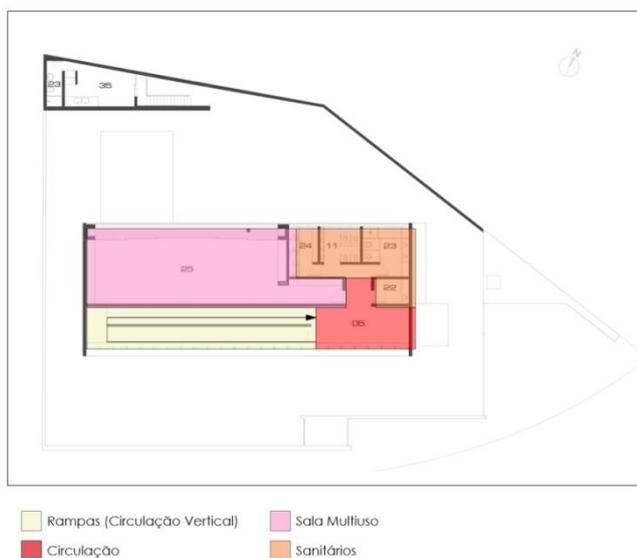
Planta Baixa Térreo - Prime Time, São Paulo.
